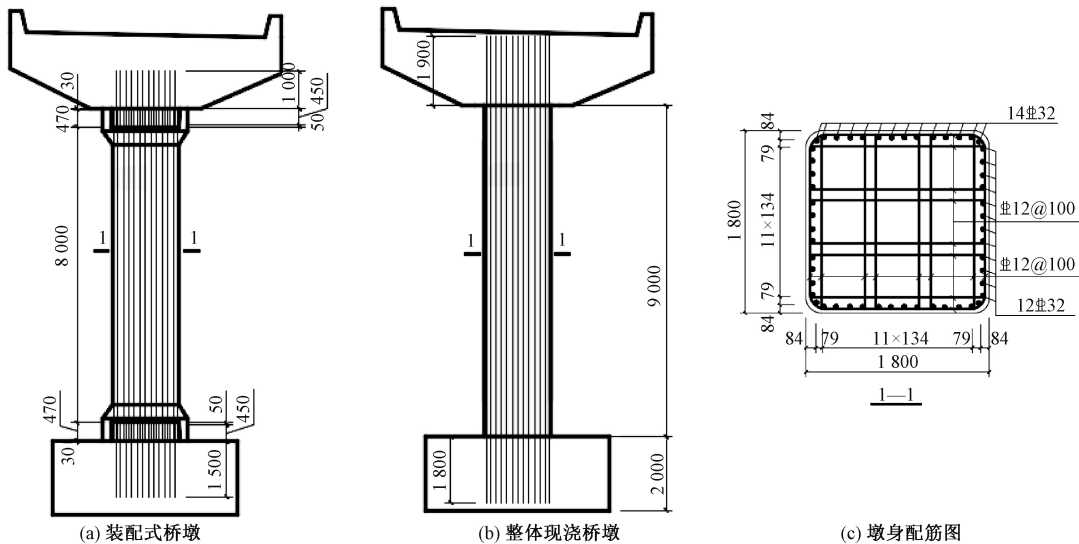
装配式桥墩和整体现浇桥墩纵向钢筋布置示意图 (mm)
